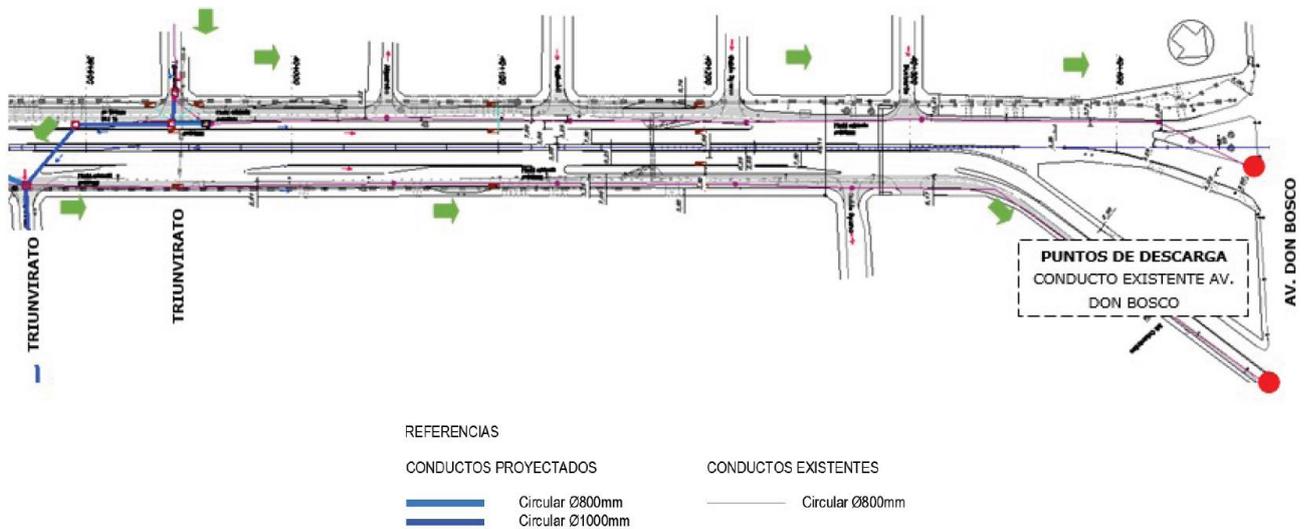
Planta subsistema descarga en conducto existente Av. Don Bosco
